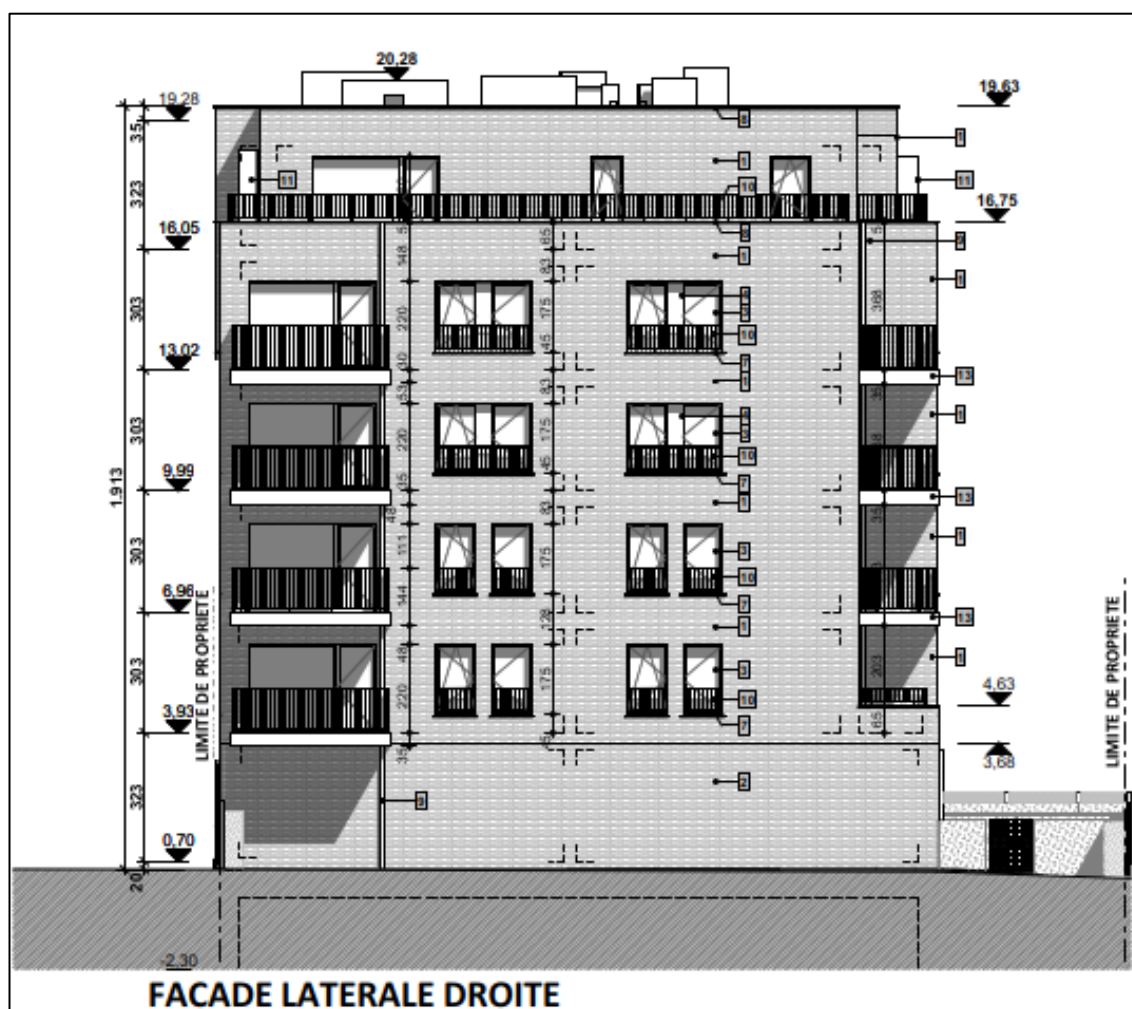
Façade latérale droite du bâtiment 2 (source : Plans PU)
